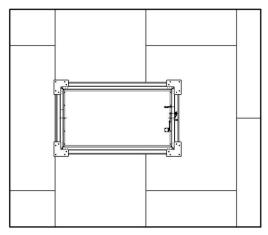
BKA-EN mit Einbaurahmen ER eingebaut (Wanddicke > 100mm)
